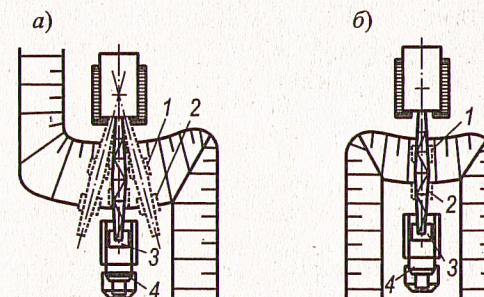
Схемы проходок экскаватора-драглайна: а — боковая проходка с разработкой грунта поперечно-челночным способом; б — лобовая проходка с разработкой грунта продольно-челночным способом; 1 — окончание набора и подъем ковша; 2 — опускание ковша и набор грунта; 3 — разгрузка ковша; 4 — автосамосвал
